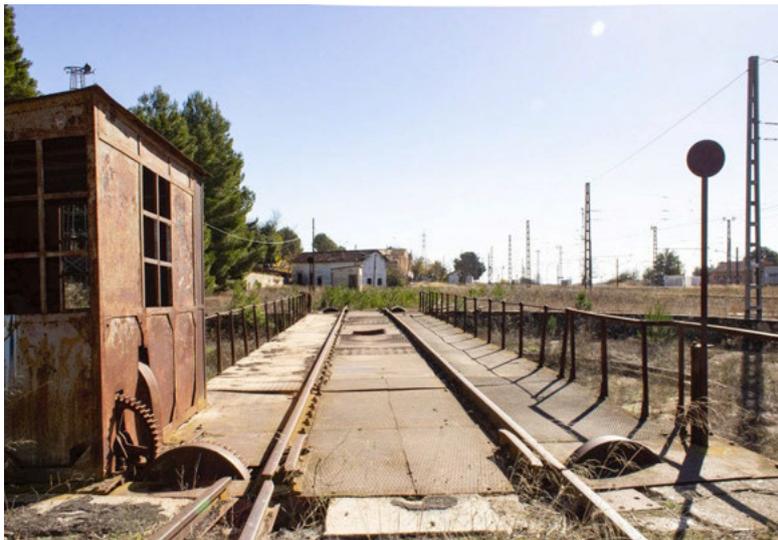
Estado actual del puente giratorio. García López de A., V (2020)
